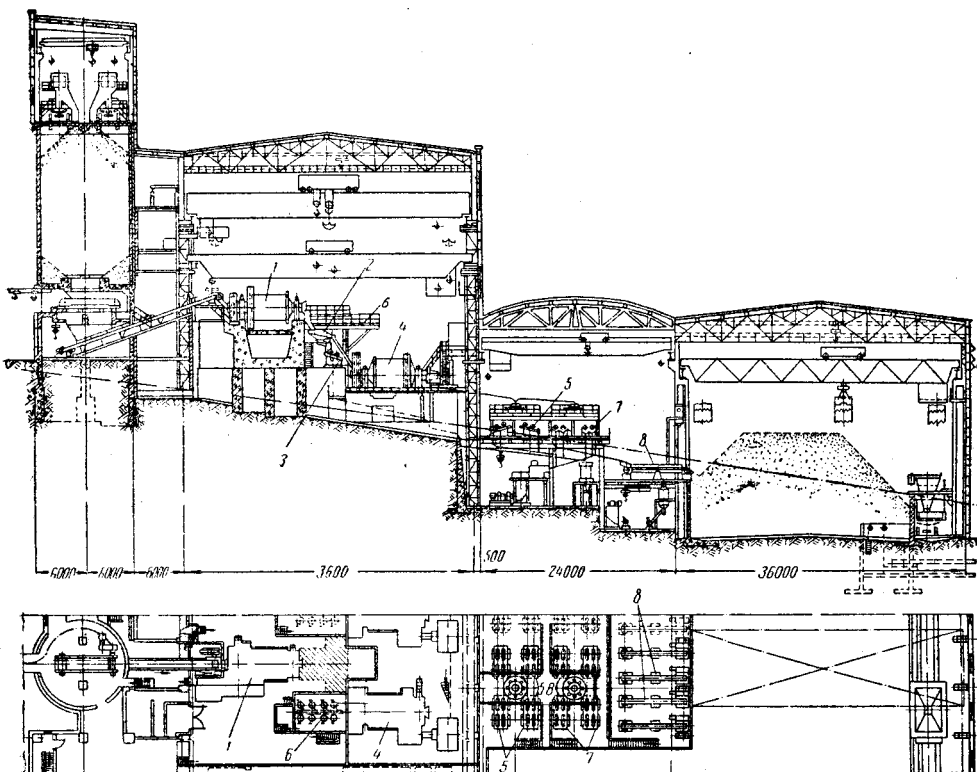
Разрез и план секции главного корпуса фабрики Коршуновского ГОКа (Механобр)
